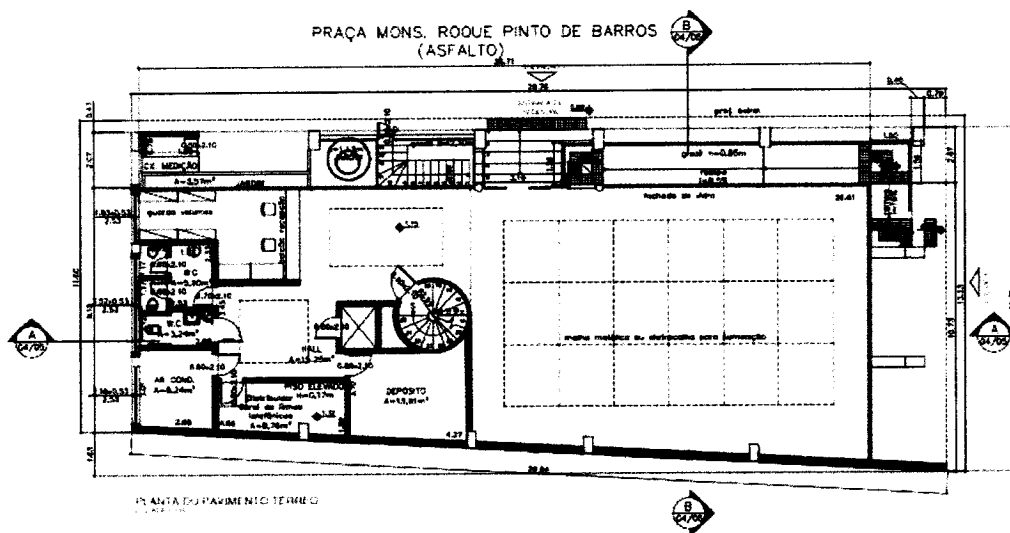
Planta do Pavimento Térreo – Galeria de Artes “Wanda Coelho Barbieri”
